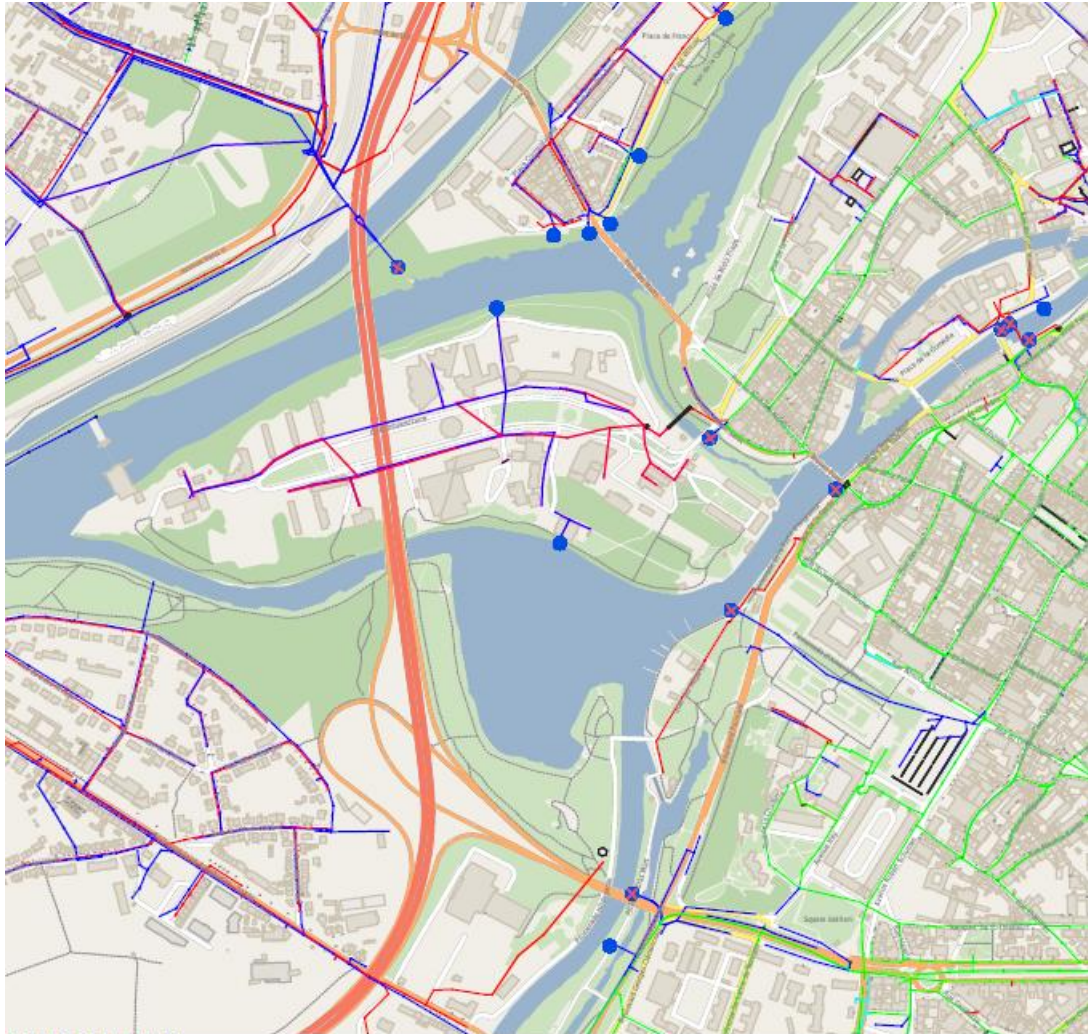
Plan des réseaux d'assainissement (en rouge : eaux usées strictes, en vert : unitaires) et d'eaux pluviales (en bleu) aux alentours du plan d'eau de Metz (Source : Ville de Metz)
